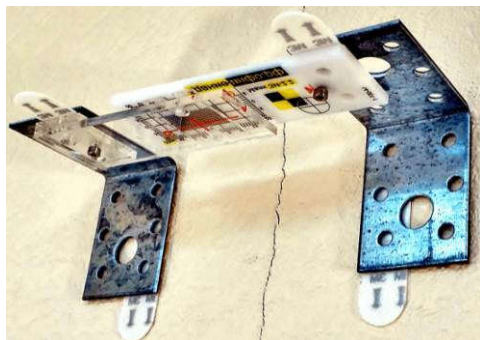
,2. Конструкція багаторазового (інвентарного) маяка
